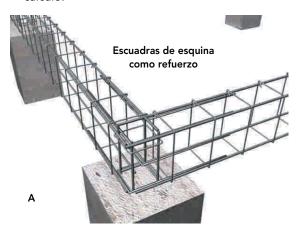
39 : Armadura de los cimientos de hormigón.
